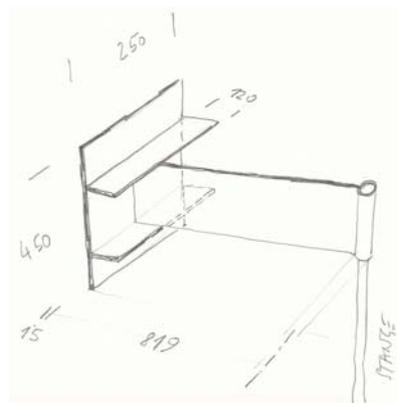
Detailskizze Abhängung für Bauteile vor der Fassade
